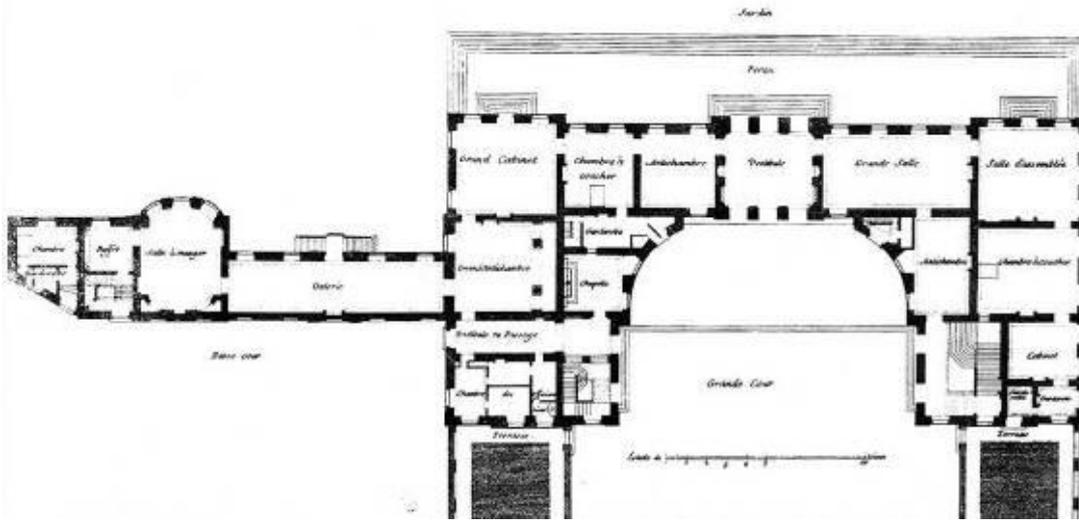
Schloss Choisy, Grundriss, Entwurf von Jaques Gabriel
